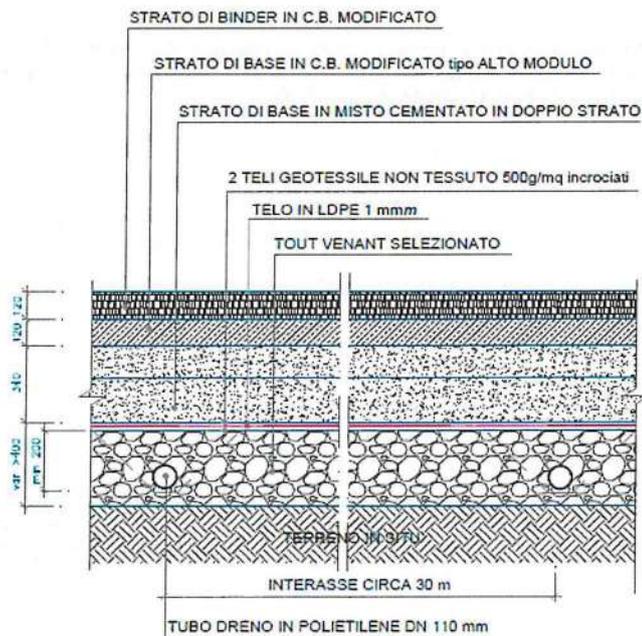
pacchetto di pavimentazione in area con copertura a tenuta di vapori.
